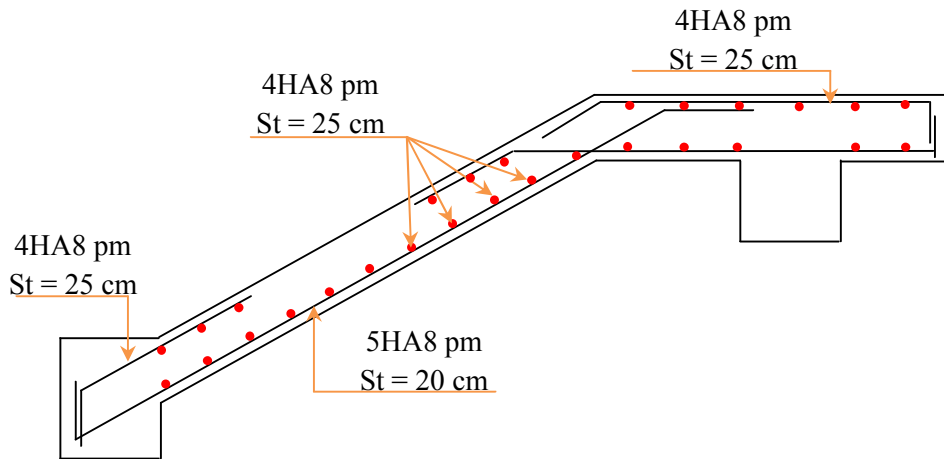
Schéma de ferrailage de l'escalier type (2)
